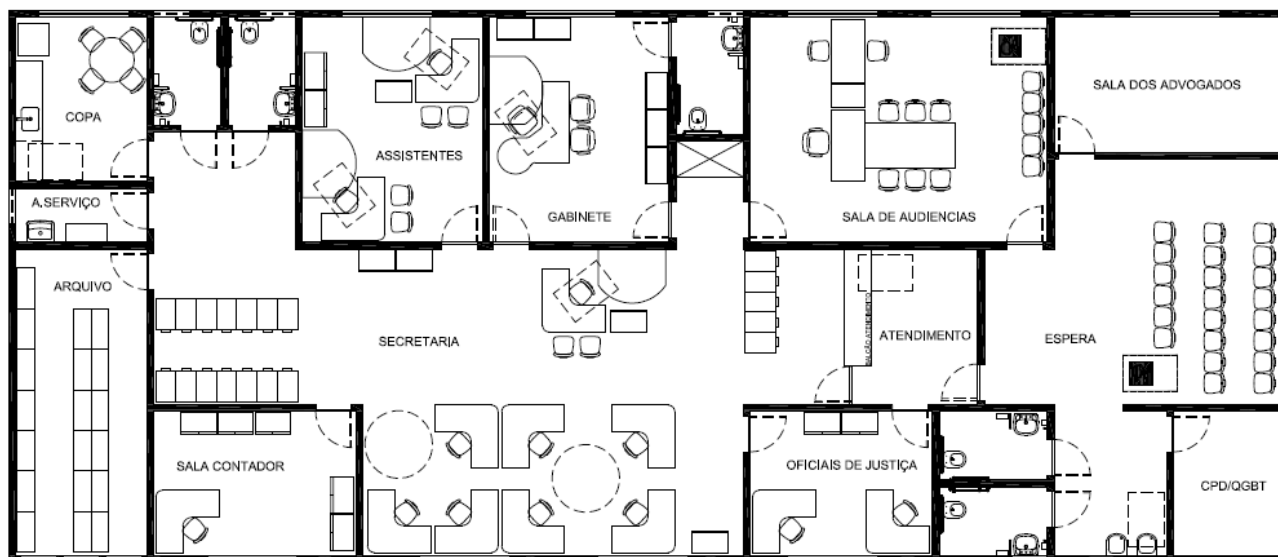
Planta Baixa Padrão de Vara do Trabalho
